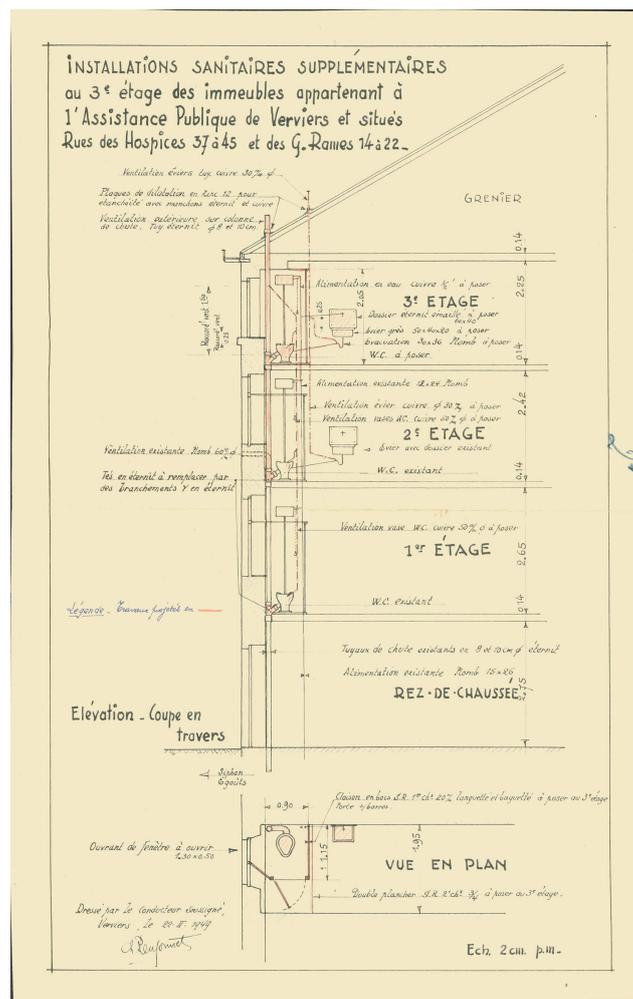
Coupe et plan de l'installation de sanitaire. Source : Archives de Verviers.
